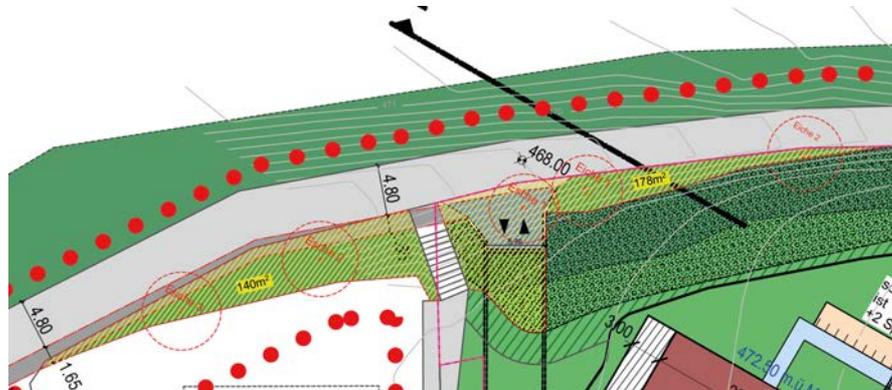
Ausschnitt der Situation Wilergasse (DBP Stockacker, 4. Auflage); zu beseitigende Heckenflächen im Umfang von 140 m² und 178 m² gelb schraffiert
